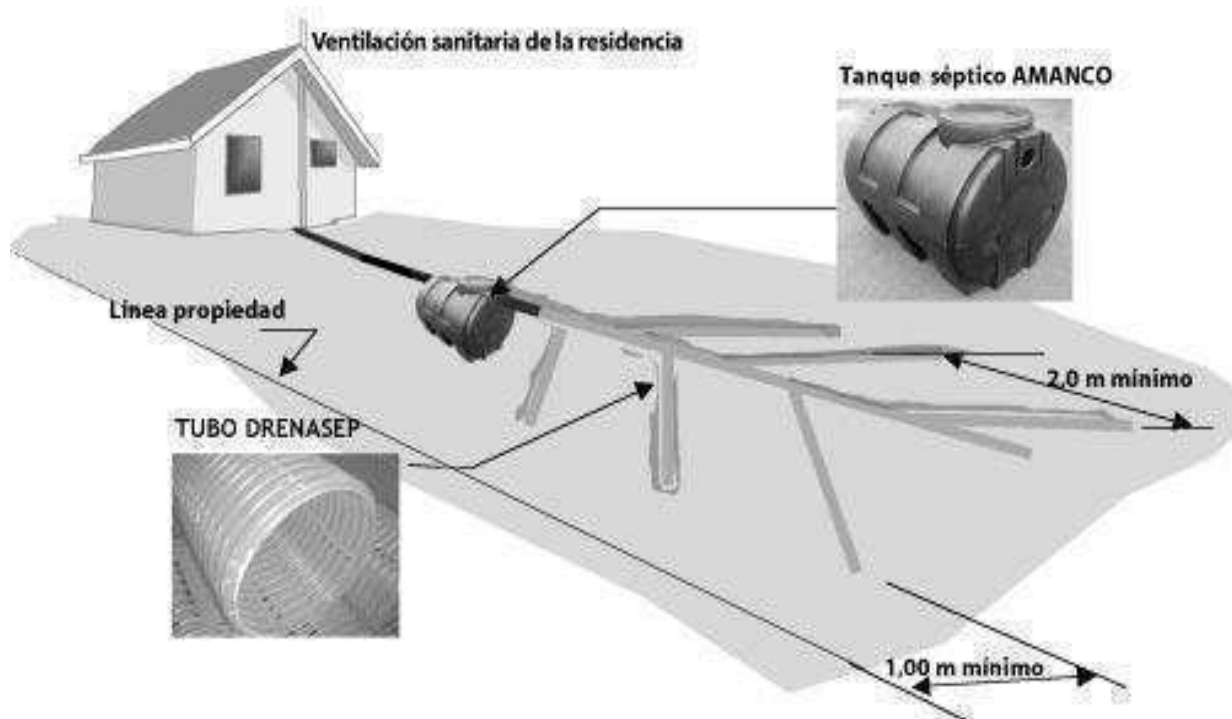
Sistema Drenasep para drenaje de tanques sépticos
